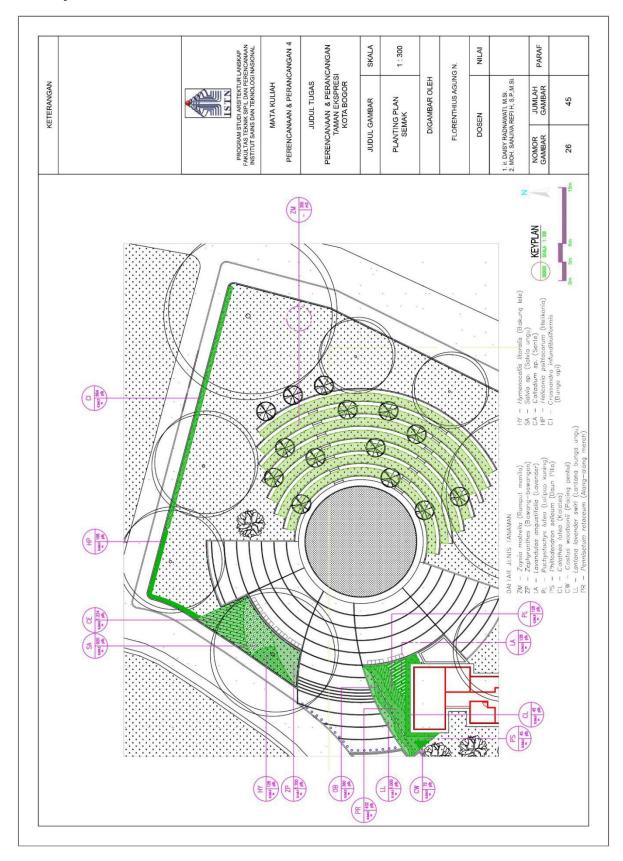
CONTOH FORMAT GAMBAR DETAIL PLAN
